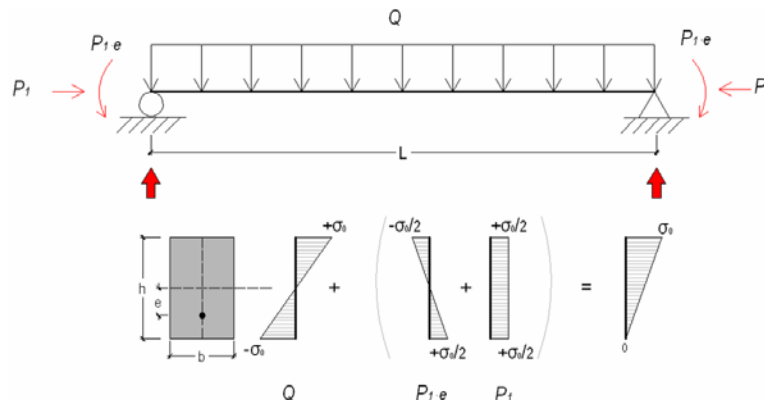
Diagrama tensional de la pieza bajo las cargas
